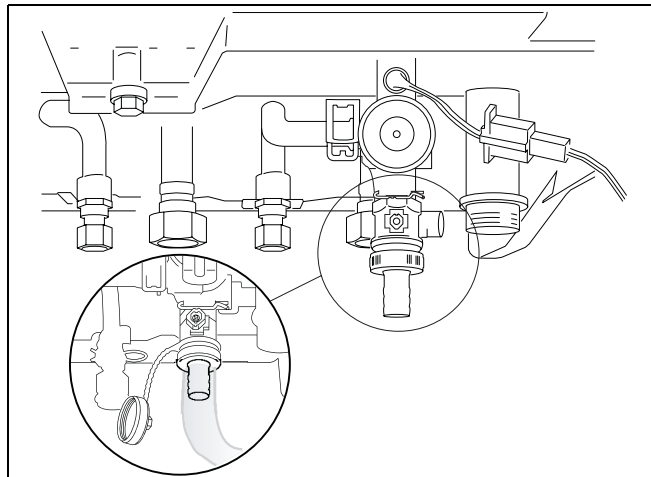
Riempimento dell'impianto (apparecchio singolo)
